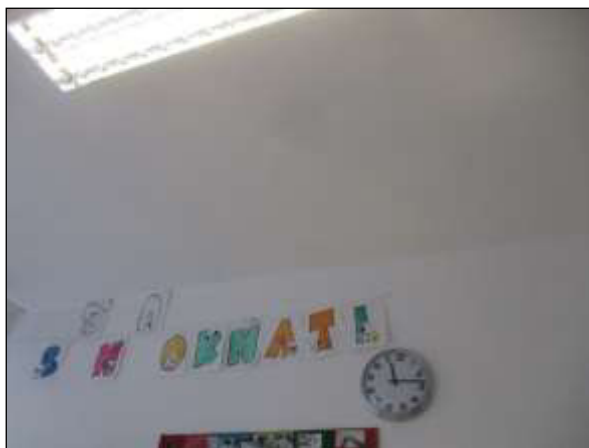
Porzione del plafone del Locale 3 al piano primo connotata da un grado di aderenza pessimo dello strato di finitura.
